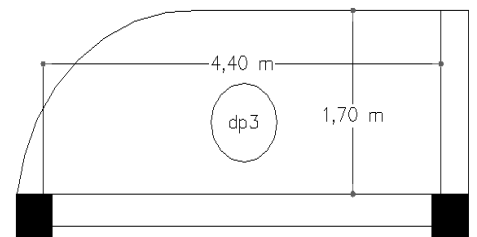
dalle pleine sur deux appuis terrasse accessible.
